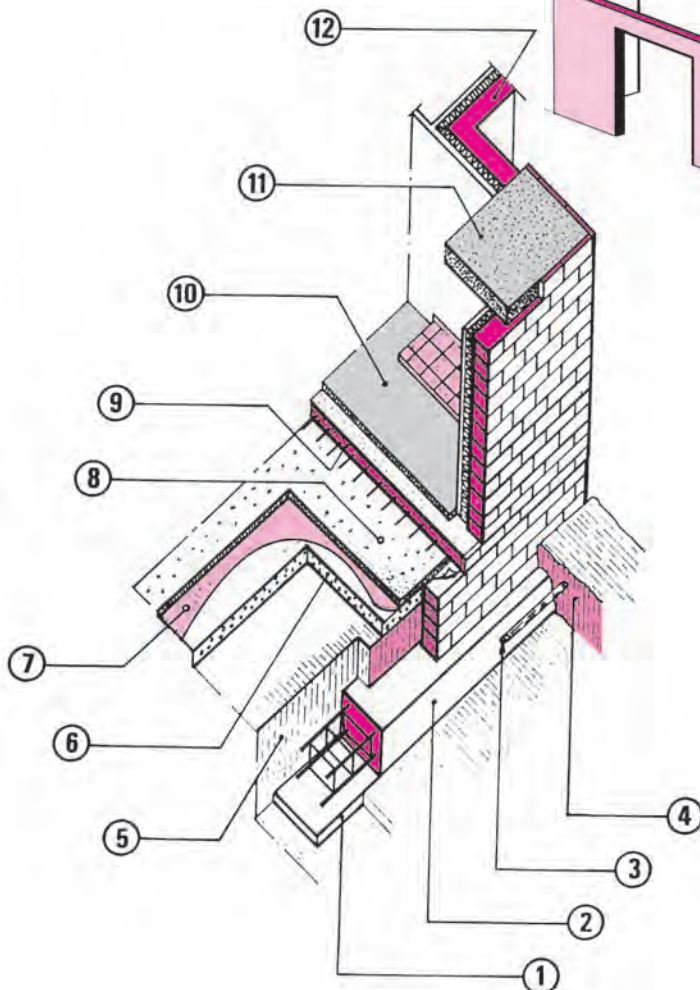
Vue des murs et poteaux du rez-de-chaussée
